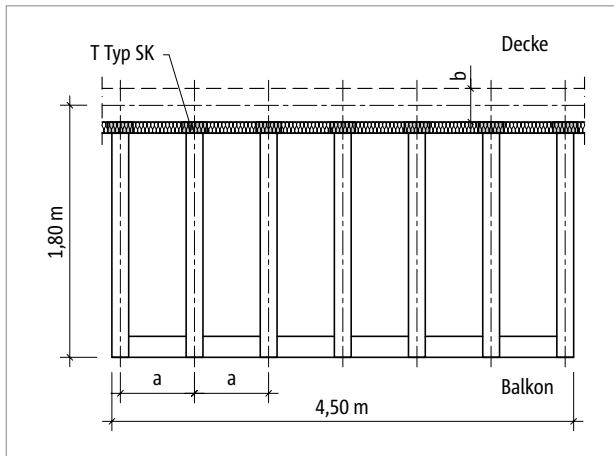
Schöck Isokorb® RT Typ SK: Grundriss
